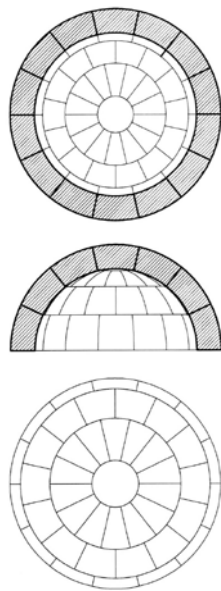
Planta, alzado seccionado y planta cenital. (Elaboración propia)
